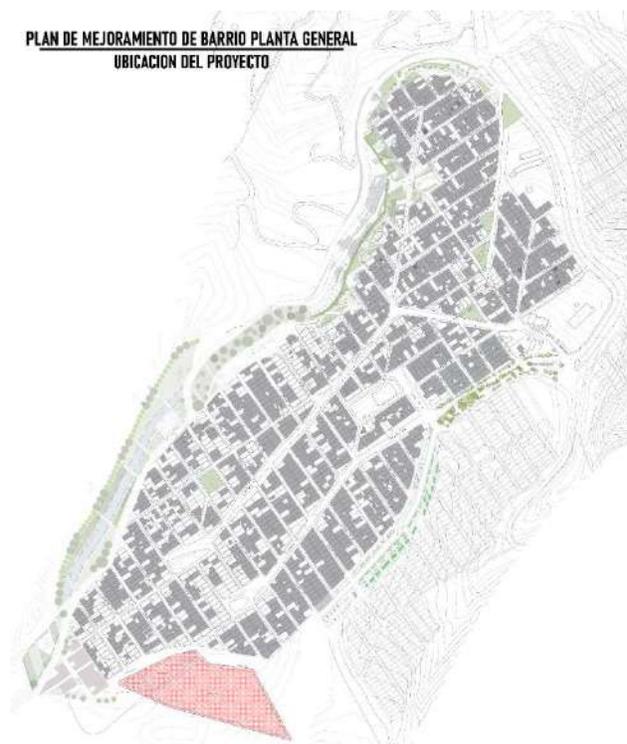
Planta de localización de equipamiento frente al plan de mejoramiento de barrio Fuente:
